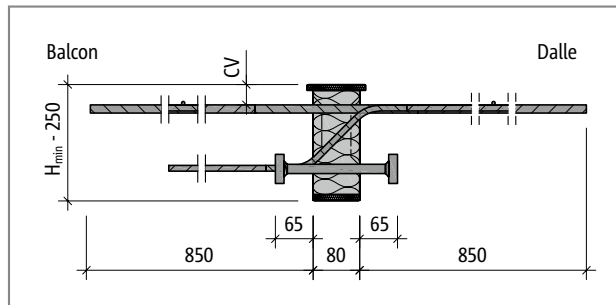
Schöck Isokorb® T Type K-M12 : Coupe du produit
